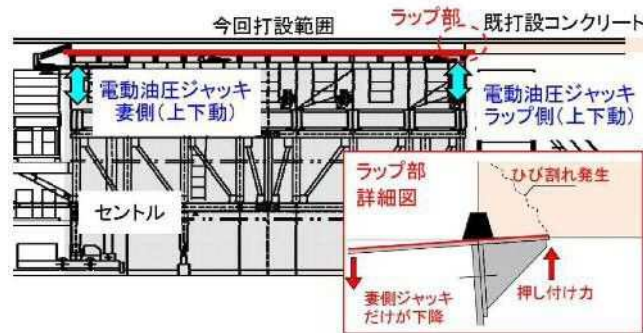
型枠設置時の操作の誤りによるひび割れ発生¹²⁾
